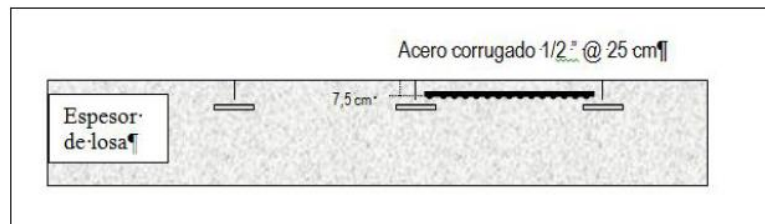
Detalles del reforzamiento de losas con una parrilla de acero.
